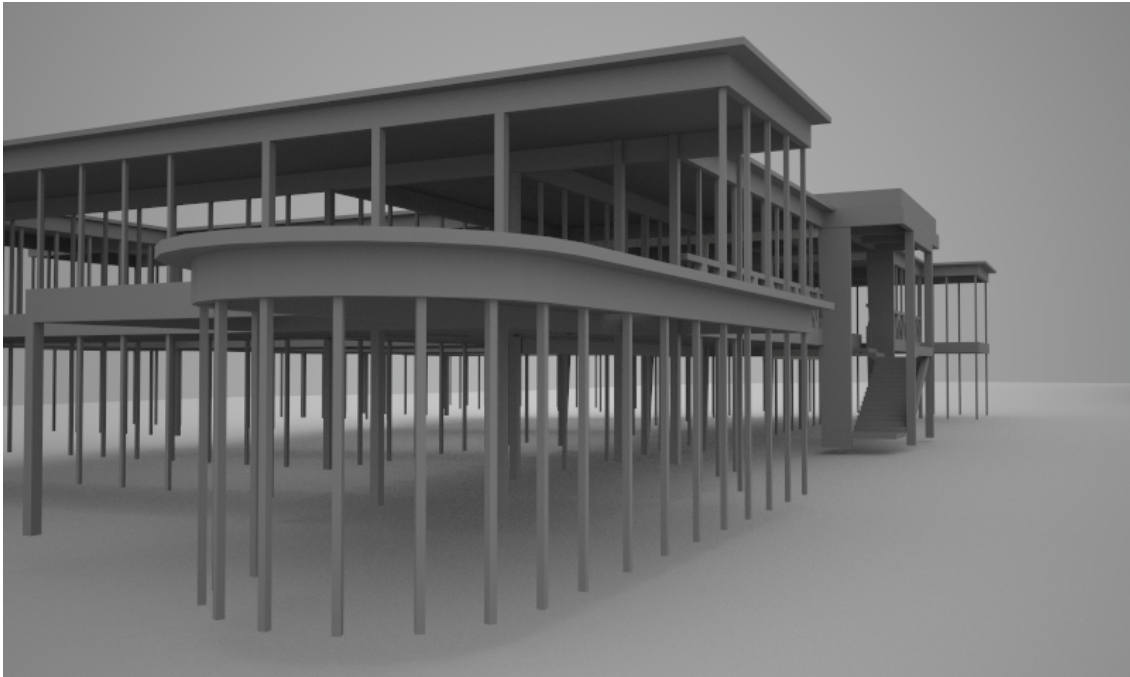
Estrutura da despensa. Estrutura com pilares de 10 x 10 cm e laje interior com vigas faixas. Fonte: Autor, 2014.
